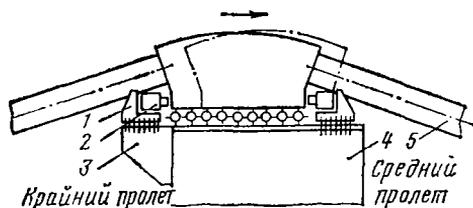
Схема перемещения опоры кабеля на пилоны:
